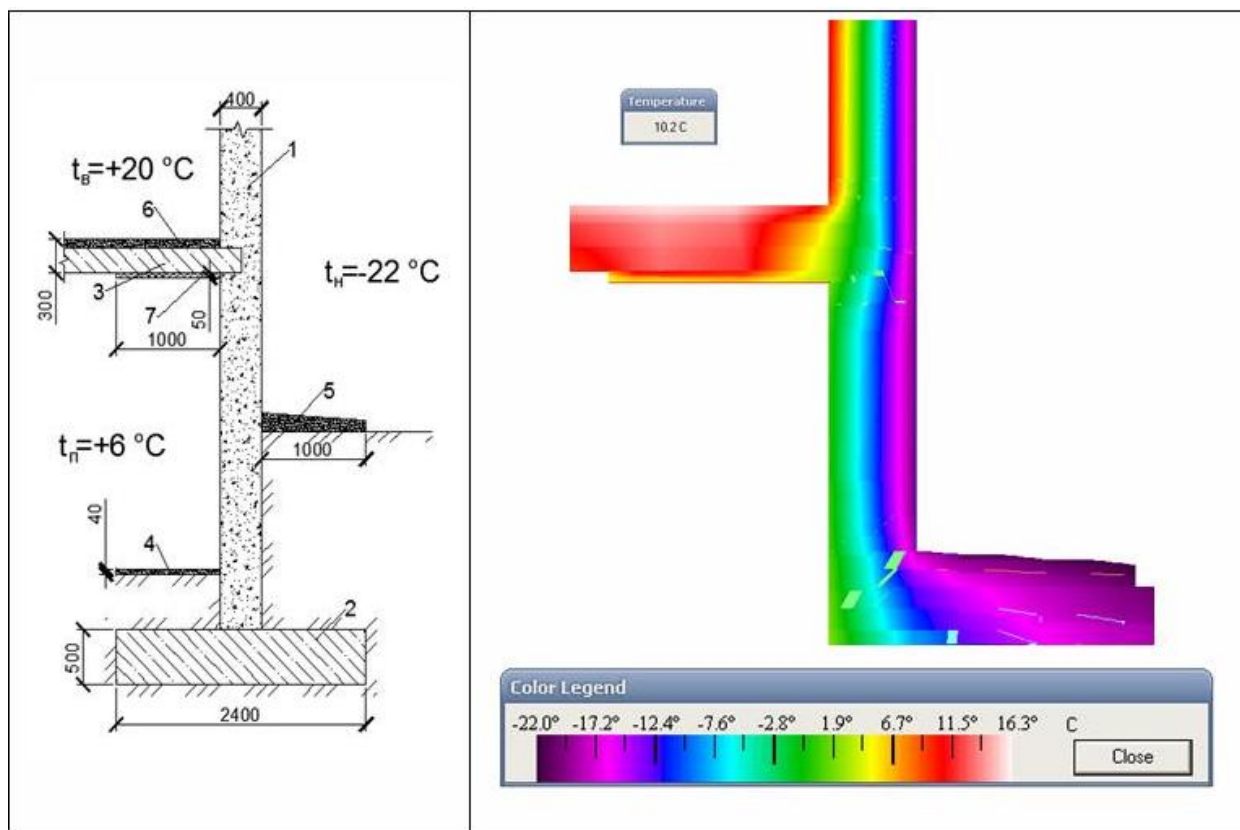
Вариант горизонтального утепления цокольного перекрытия с толщиной утеплителя 50 мм
